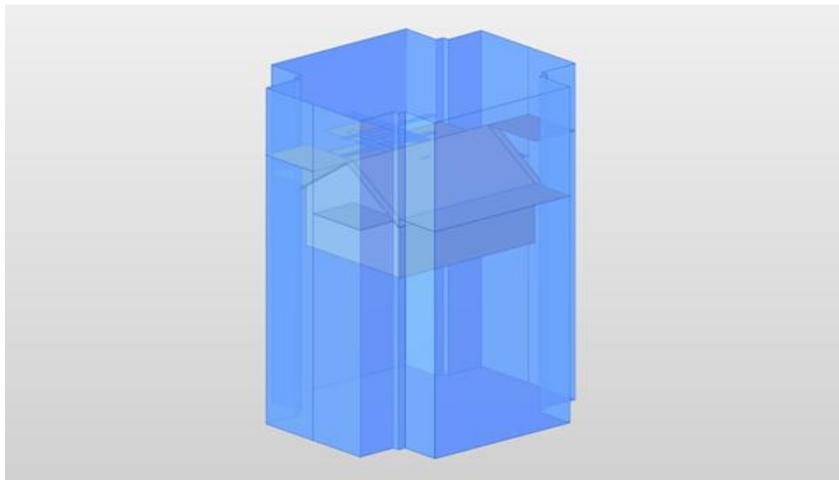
Gebäude mit Abstandsraum in der Autorensoftware Revit.
